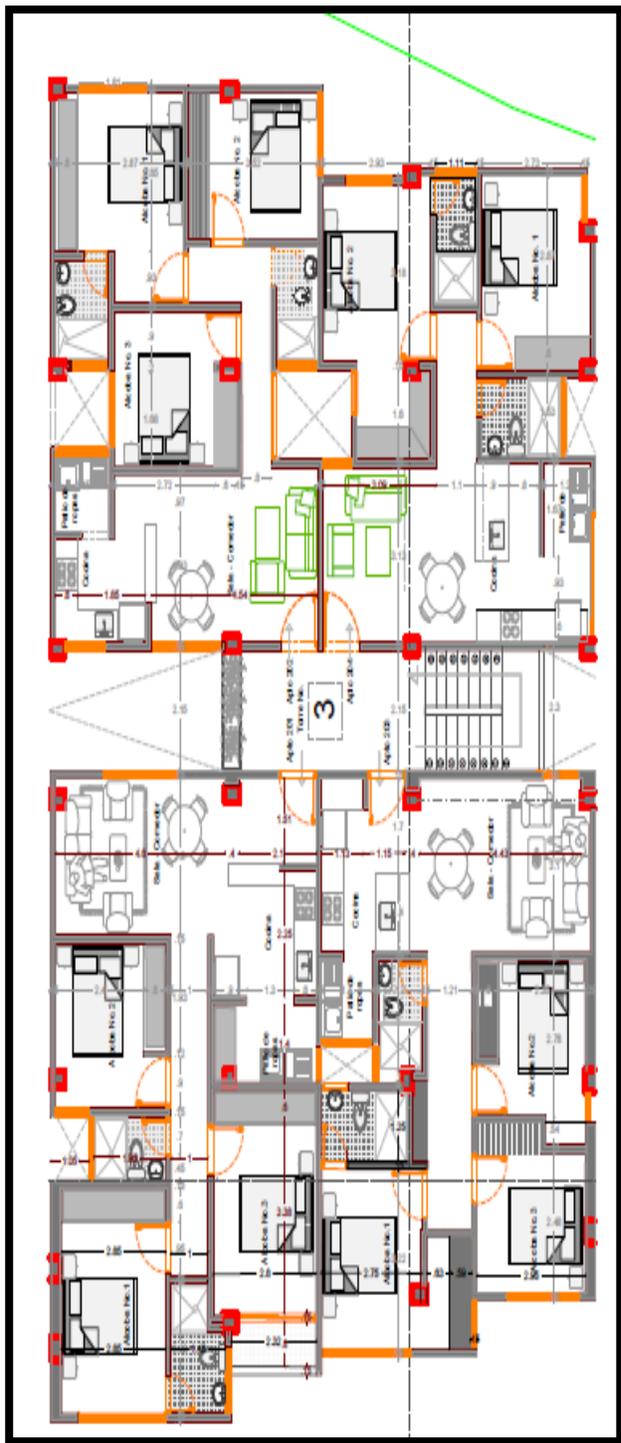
Plano Arquitectónico "planta 2, 3, 4,5"
